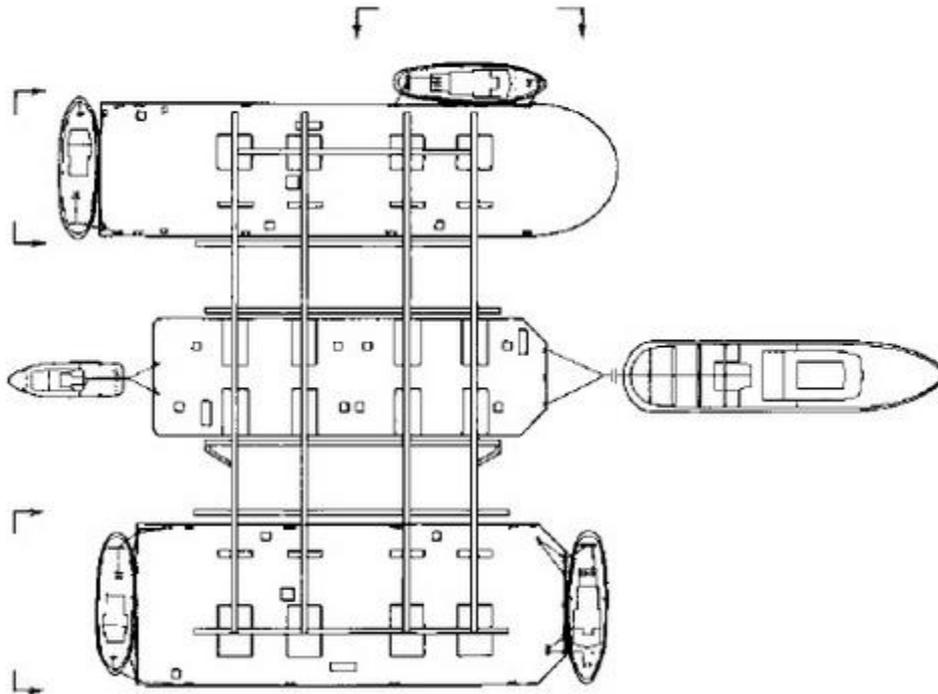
Configuración de remolque para el transporte de la cubierta Statjord B GBS. Fuente: *Construction of Marine and Offshore Structures*.
